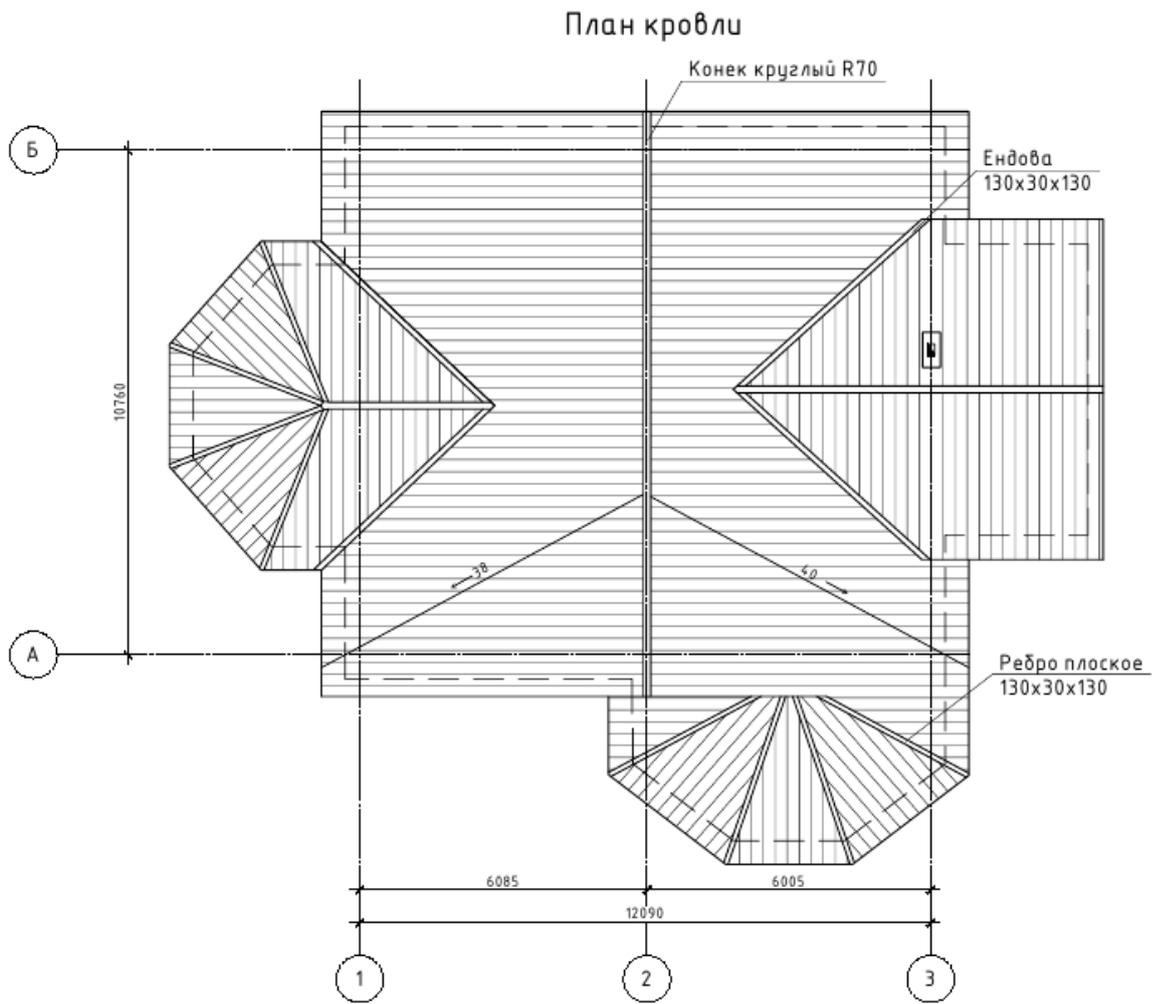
Пример оформления плана кровли малоэтажного жилого дома
